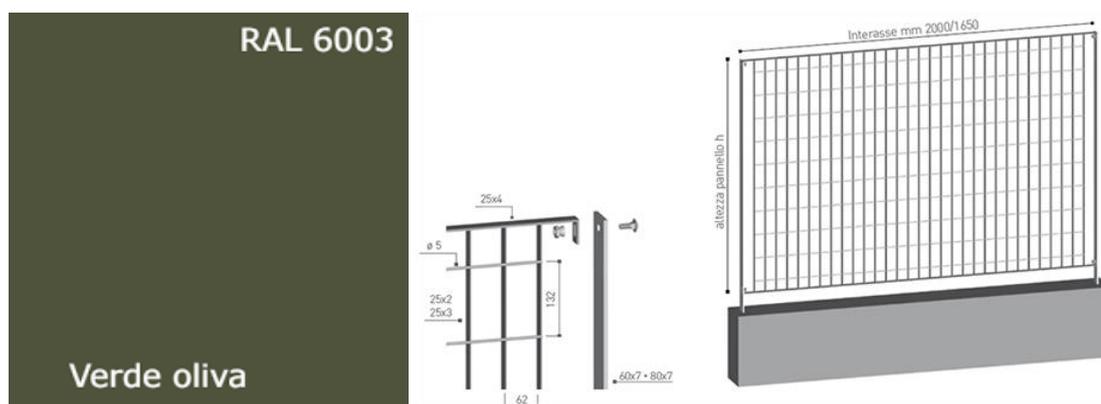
a Esempio di Colorazione della Recinzione Perimetrale delle Opere di progetto
